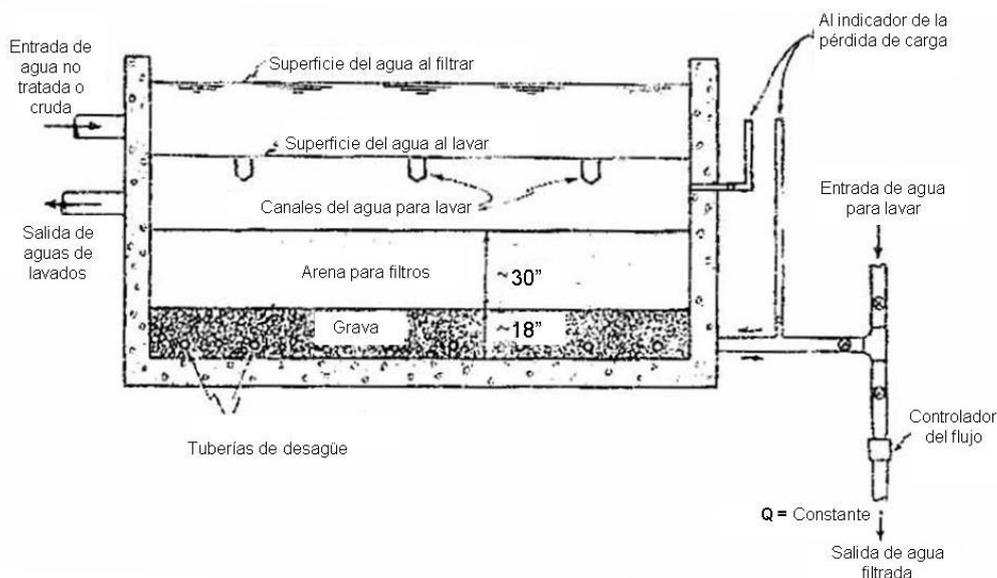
SECCIONES TRANSVERSALES DE FILTROS DE ARENA.
